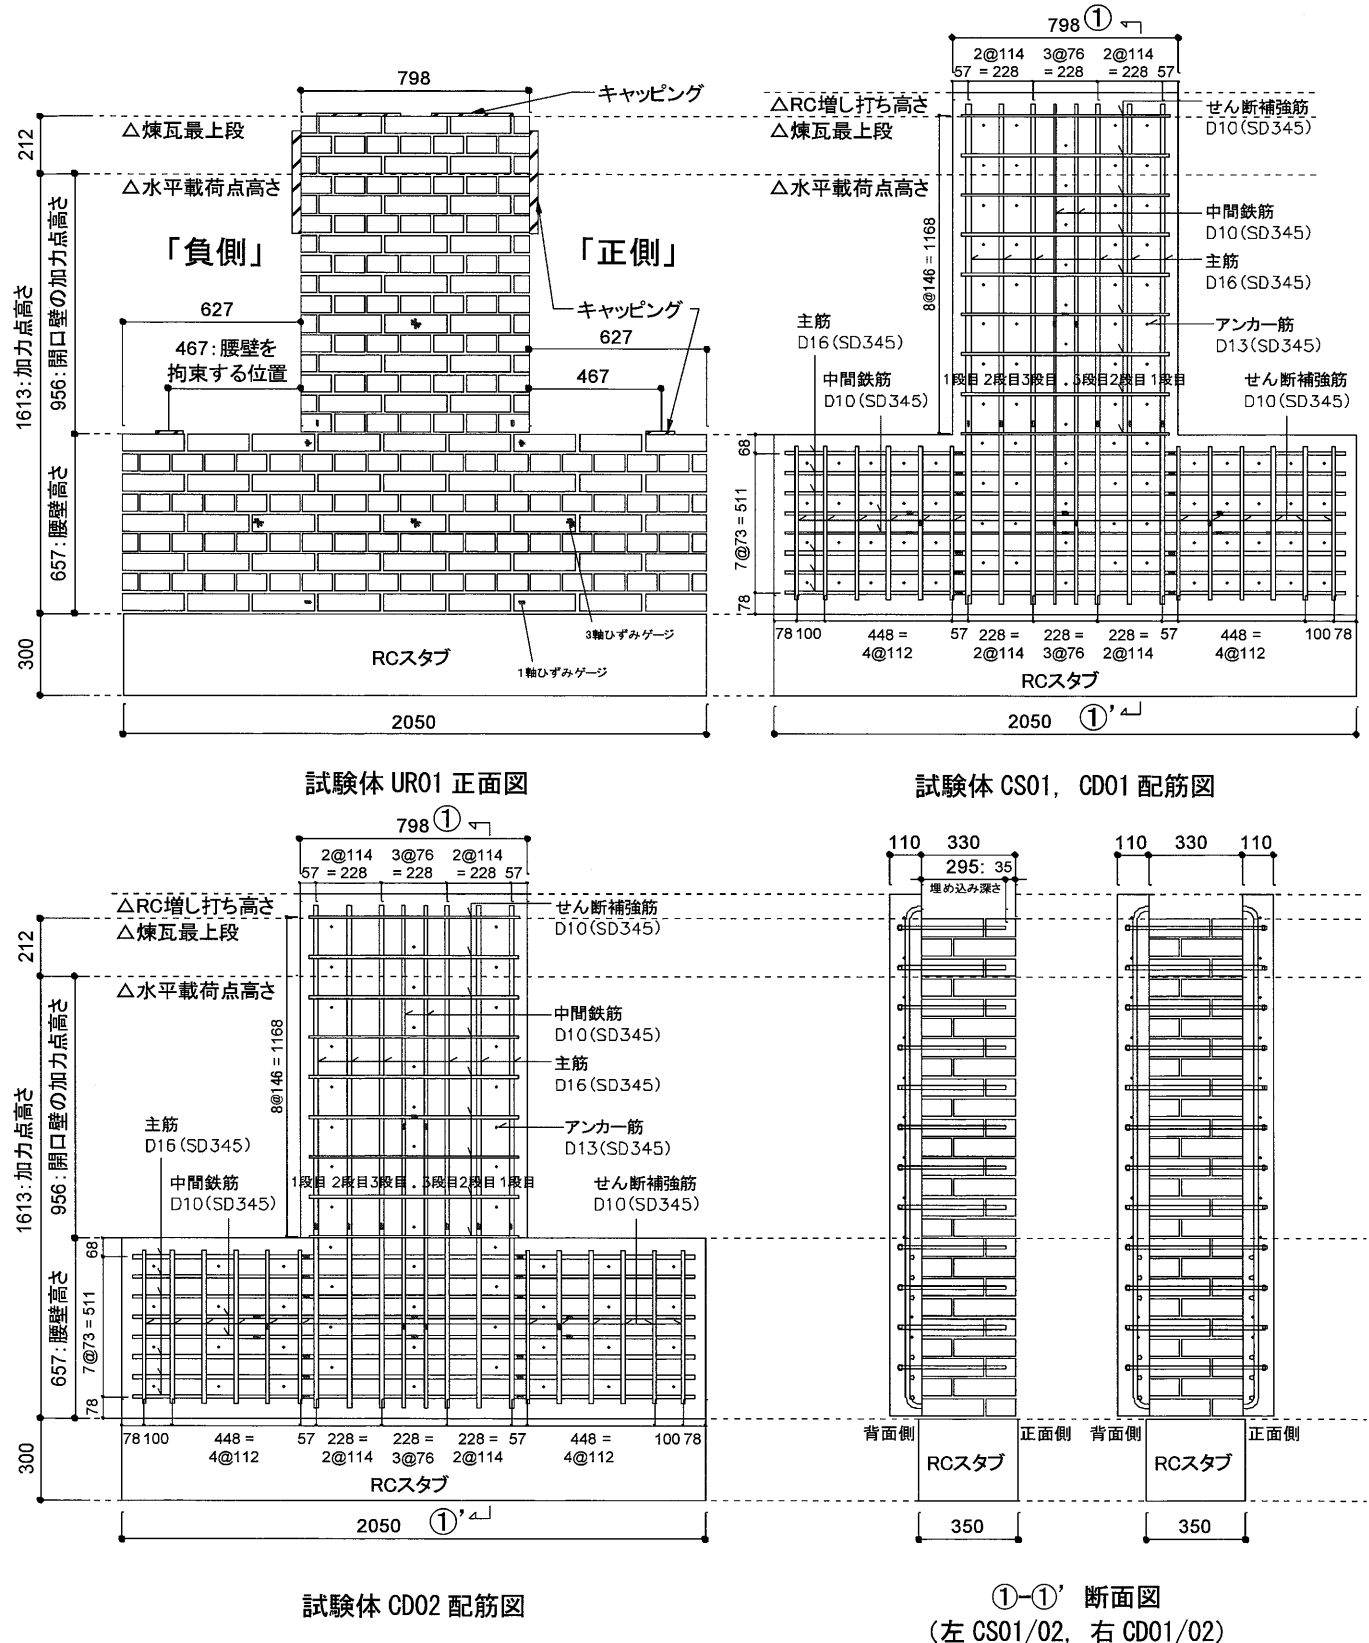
壁試験体の形状、配筋図、ひずみゲージ貼付け位置 (単位: mm)
